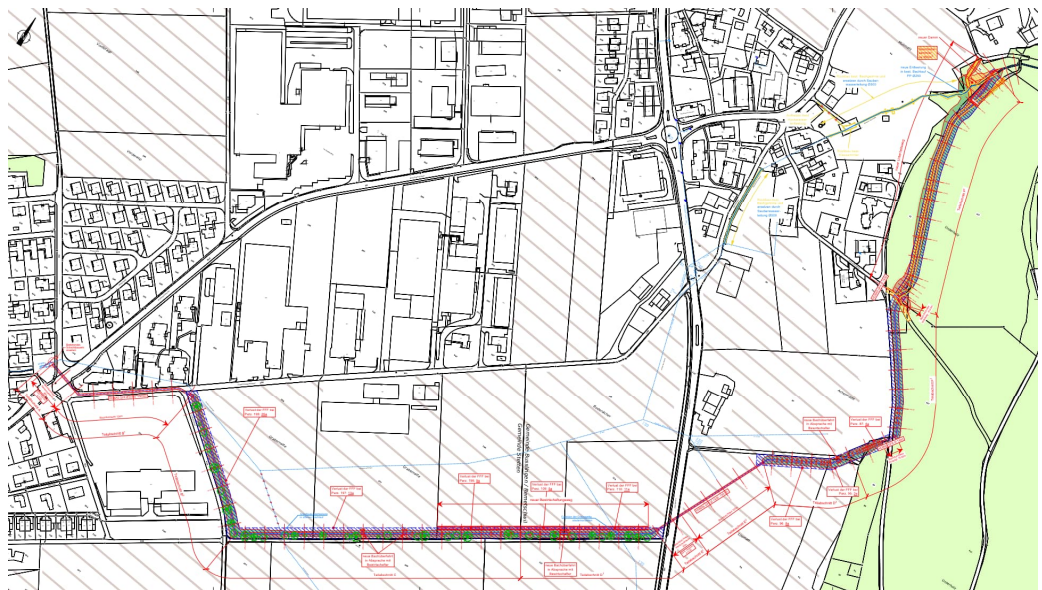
Situationsplan Renaturierung und Hochwasserschutz Dorfbach Busslingen (Stand: Auflageprojekt)
